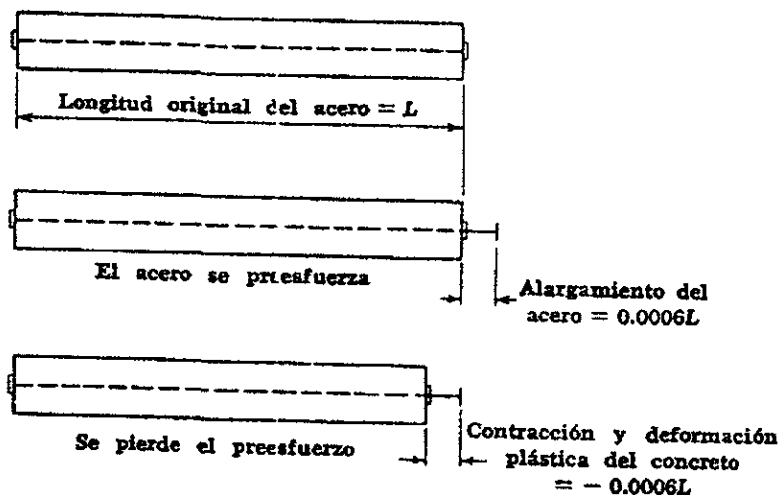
Preesfuerzo del concreto con acero estructural ordinario
